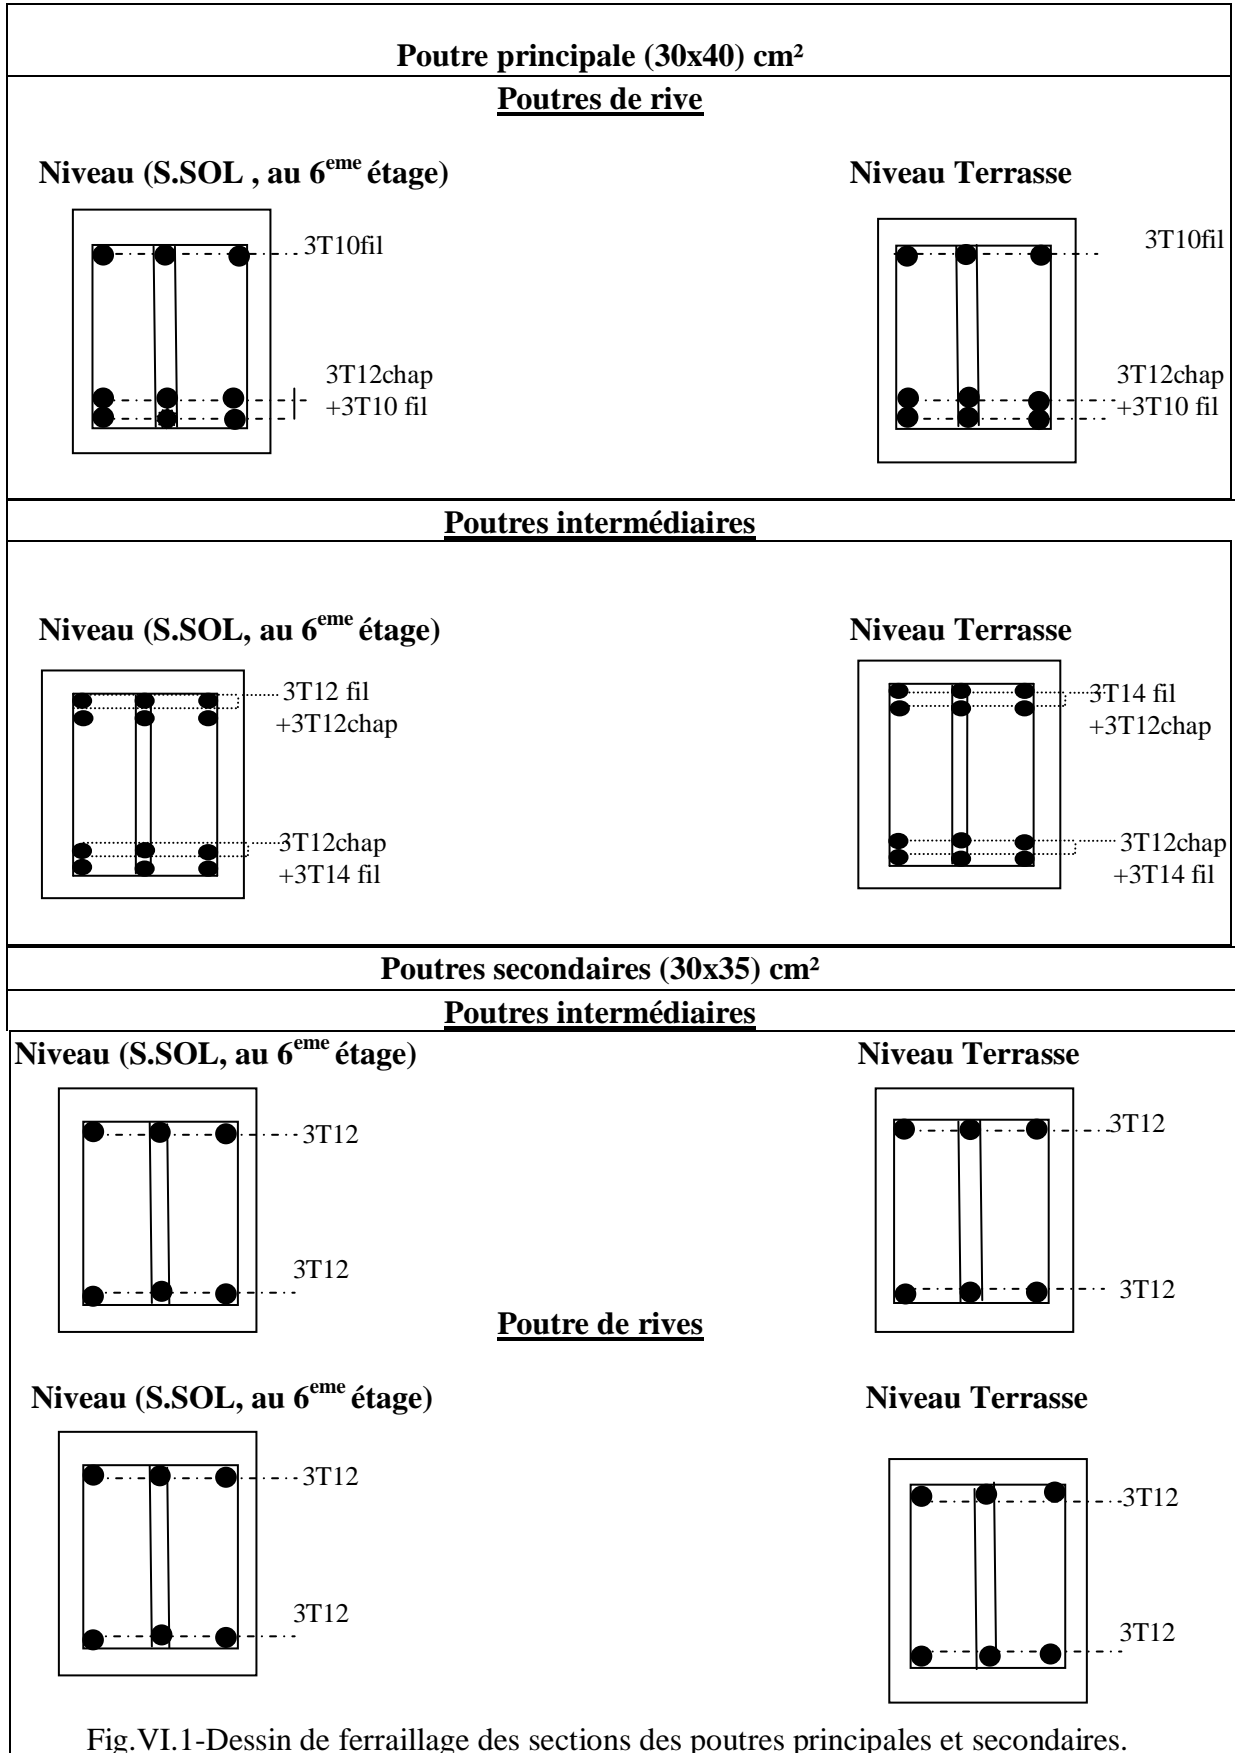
Dessin de ferrailage des sections des poutres principales et secondaires.
